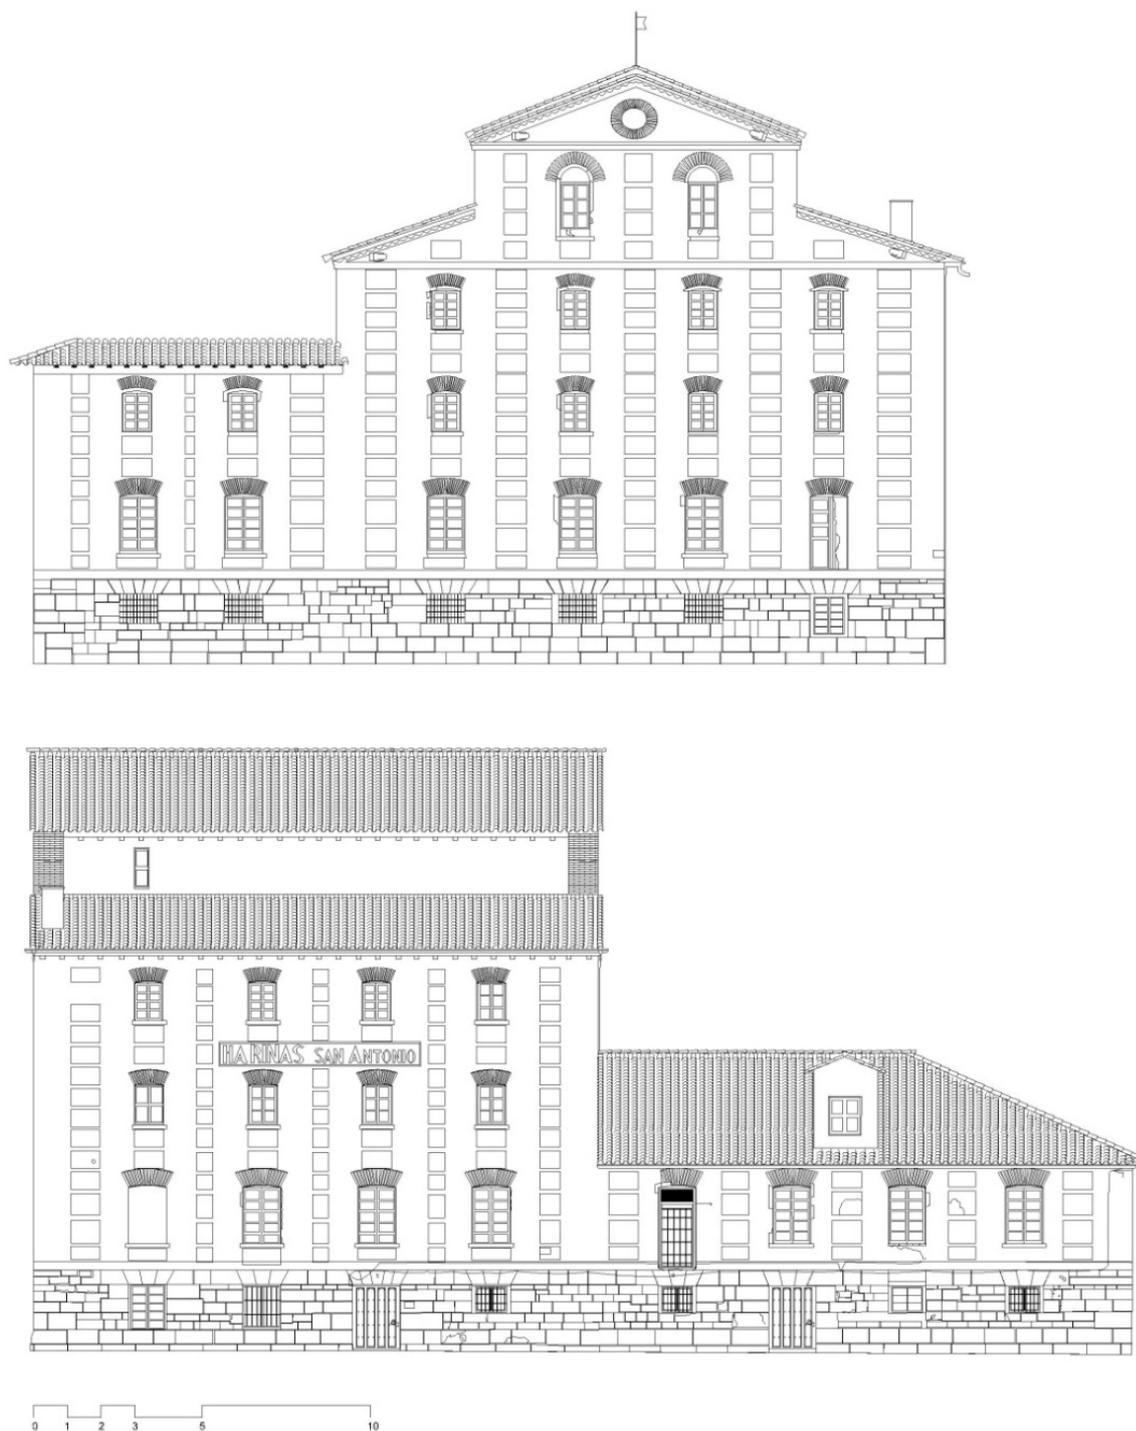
Alzado este (superior) y alzado sur (inferior). Imagen cedida por el Laboratorio de Fotogrametría Arquitectónica de la Universidad de Valladolid.
